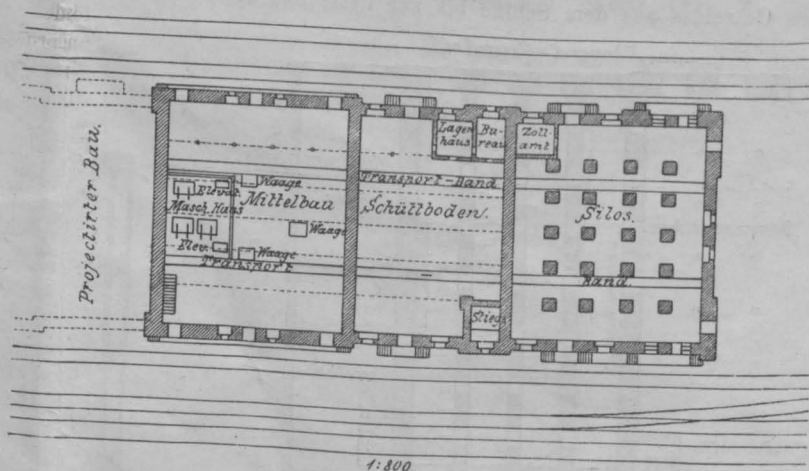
Grundriss des Lagerhauses in Worms. 1:800.
